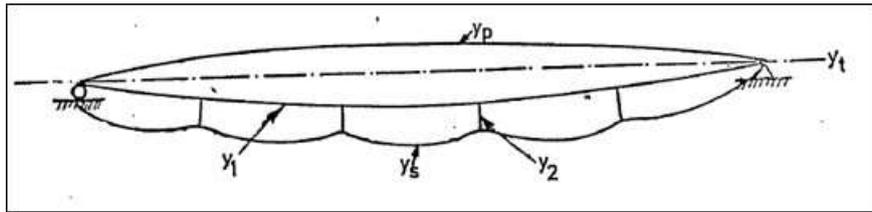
Déformées, lorsque le tablier comprend des poutres maîtresses, des entretoises et des longerons
